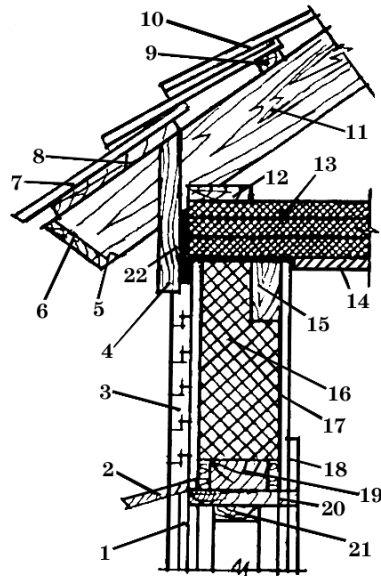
Сечение наружной стены каркасной конструкции с заполнением. Узел кровли, свеса, карниза и фриза с окном. 1 – наличник; 2 – верхний слив; 3 – обшивка тесом, рейками, досками; 4 – костьль (фризовая доска); 5 – капельница; 6 – свес кровли (карниз); 7 – литы (доски) покрытия; 8 – постелистая доска; 9 – обрешетка; 10 – лист покрытия; 11 – стропильная нога; 12 – лежак-упор; 13 – утеплитель; 14 – потолок; 15 – балка-брус; 16 – стеновой наполнитель; 17 – обшивка; 18 – нащельник; 19 – горизонтальный брусок оконного проема; 20 – оконная коробка; 21 – промежуточный брус; 22 – гидроизоляция.
